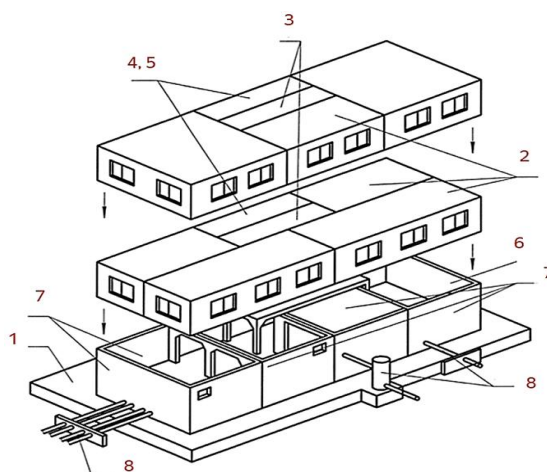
Вариант установки объемных модулей друг на друга (подземный и первые два этажа): 1 – фундамент; 2 – квартирные модульные блоки; 3 – приквартирные модульные блоки; 4, 5 – готовые модули лестнично-лифтовых узлов; 6 – модульные блоки с ребристыми стенами; 7 – модульные блоки подземного этажа; 8 – отверстия (трубы) для проведения коммуникаций (соответствует фигуре 2 [7])
